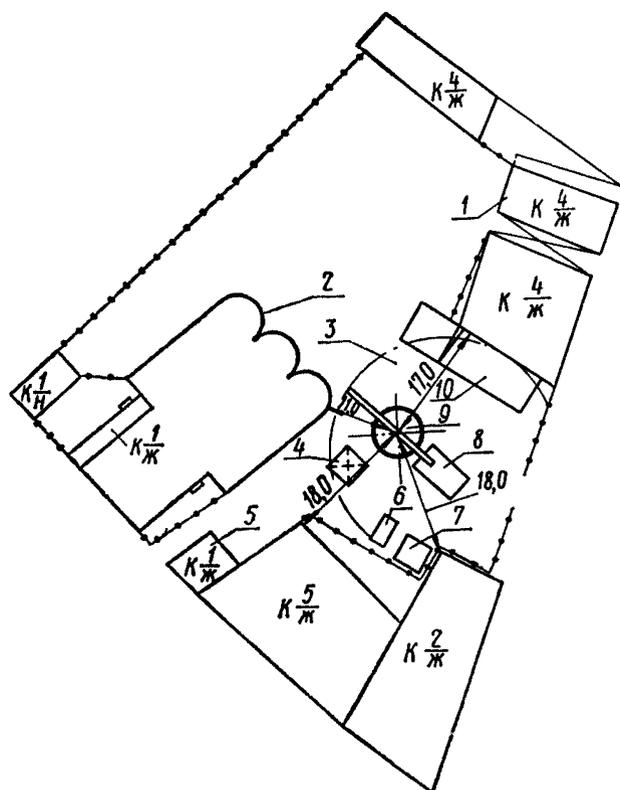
План шахтной площадки в период проходки ствола № 832 методом погружения крепи в тиксотропной рубашке в зоне неустойчивых и плывуновых пород:
